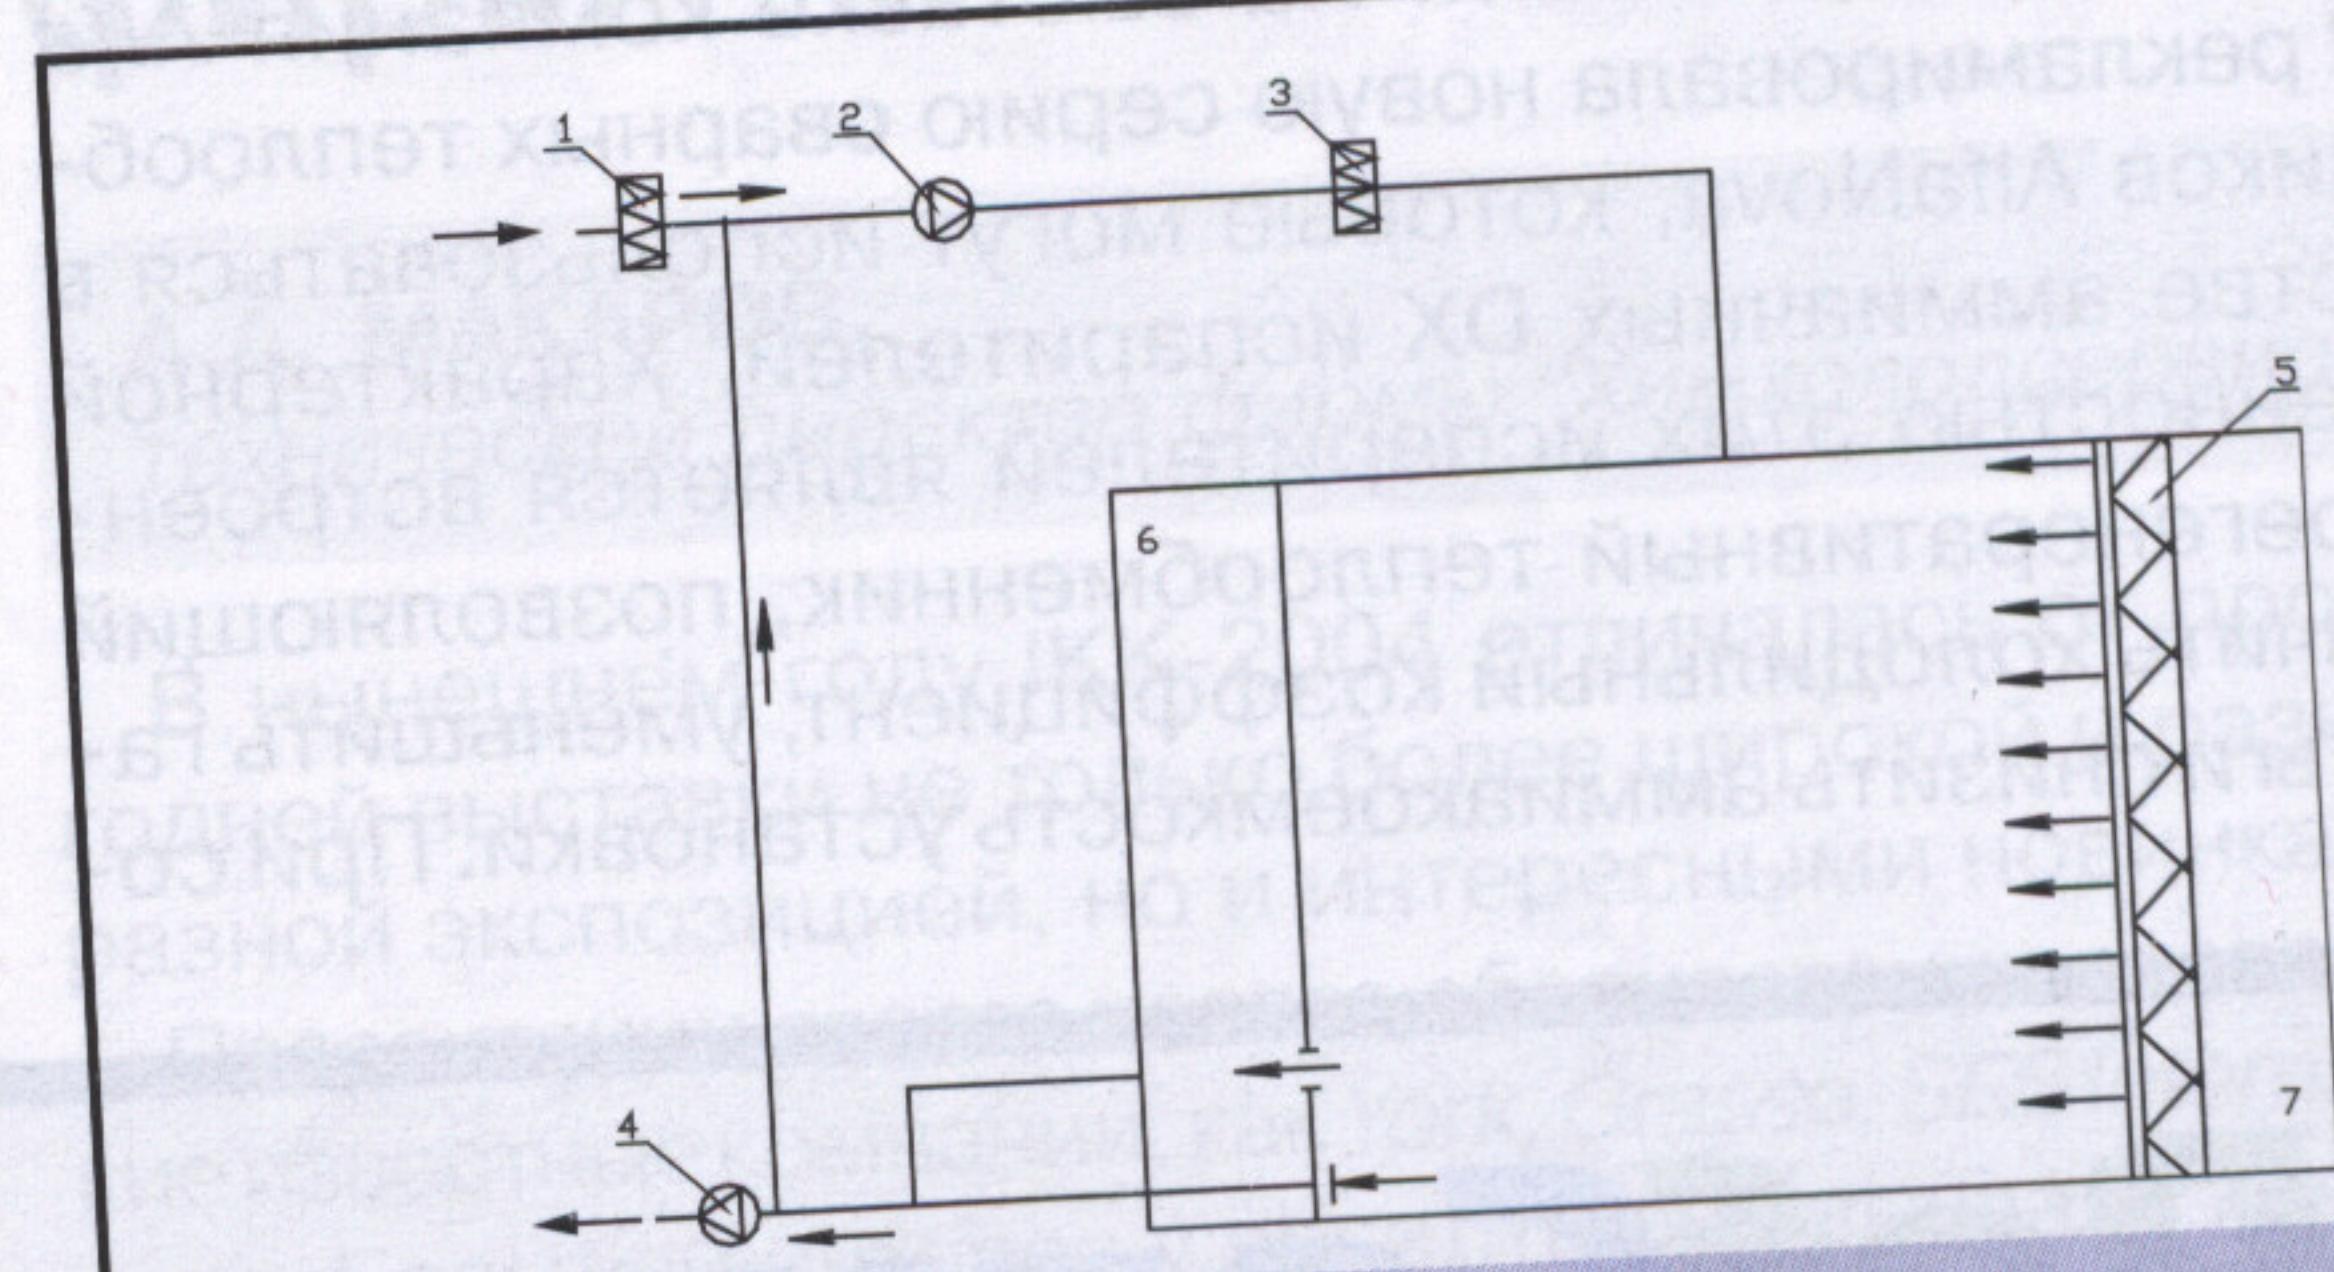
Схема вентиляции в помещении с односторонним горизонтальным потоком:
